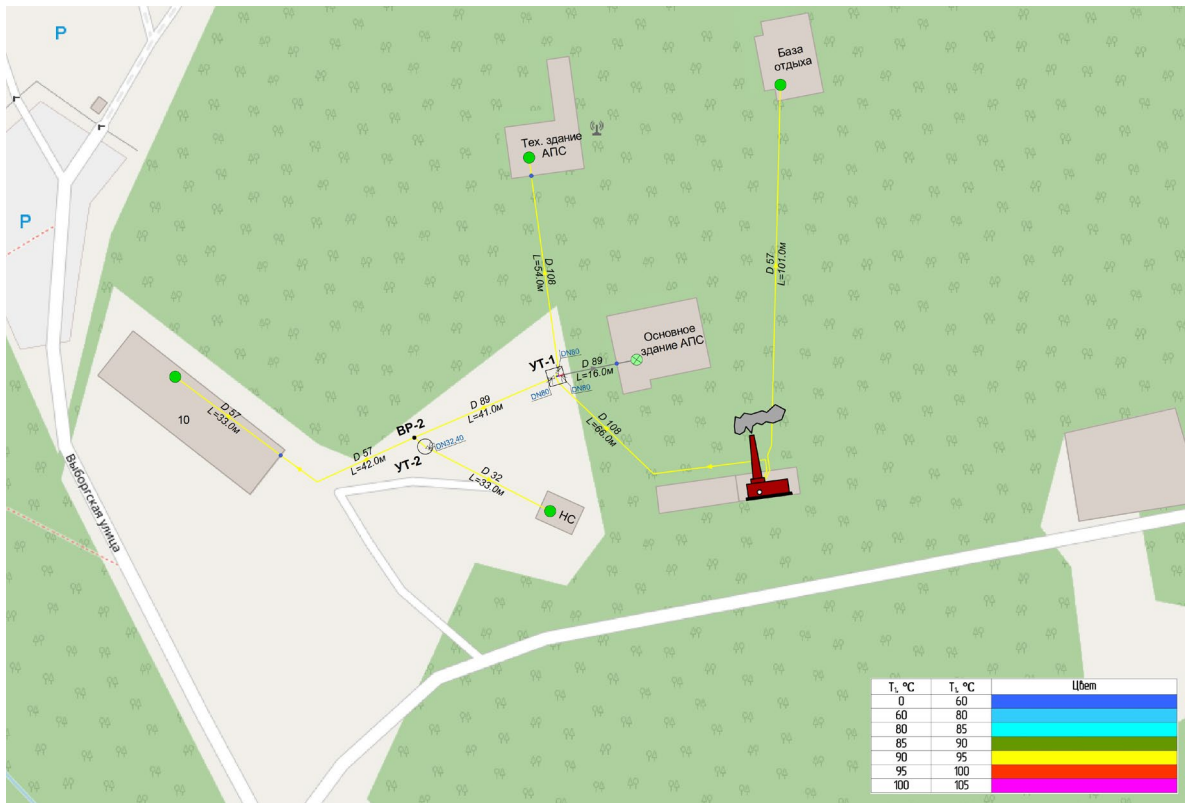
Схема тепловых сетей от котельной, ул. Заозерная, 15 с раскраской по температуре теплоносителя в подающем трубопроводе
